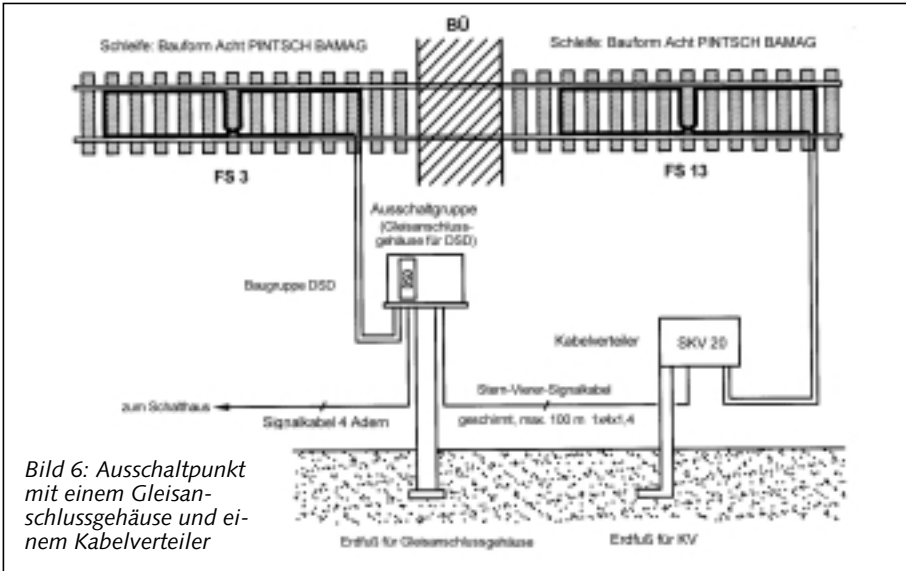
Ausschaltpunkt mit einem Gleisanschlussgehäuse und einem Kabelverteiler
